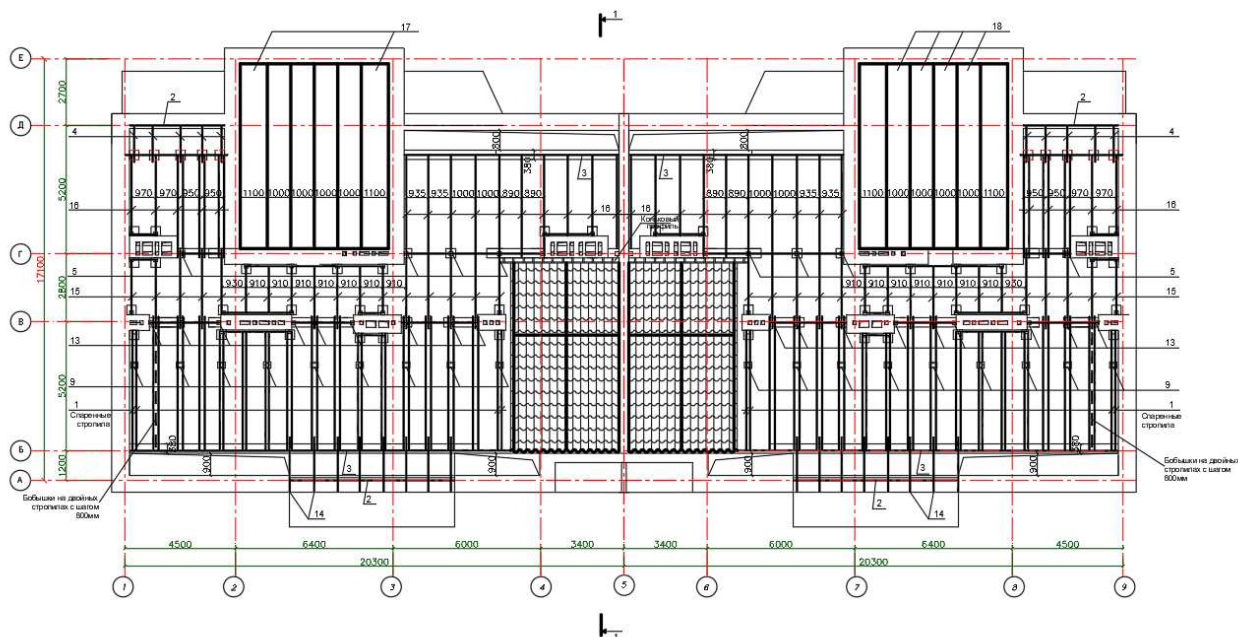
К расчету стропильной системы: схема раскладки стропил
